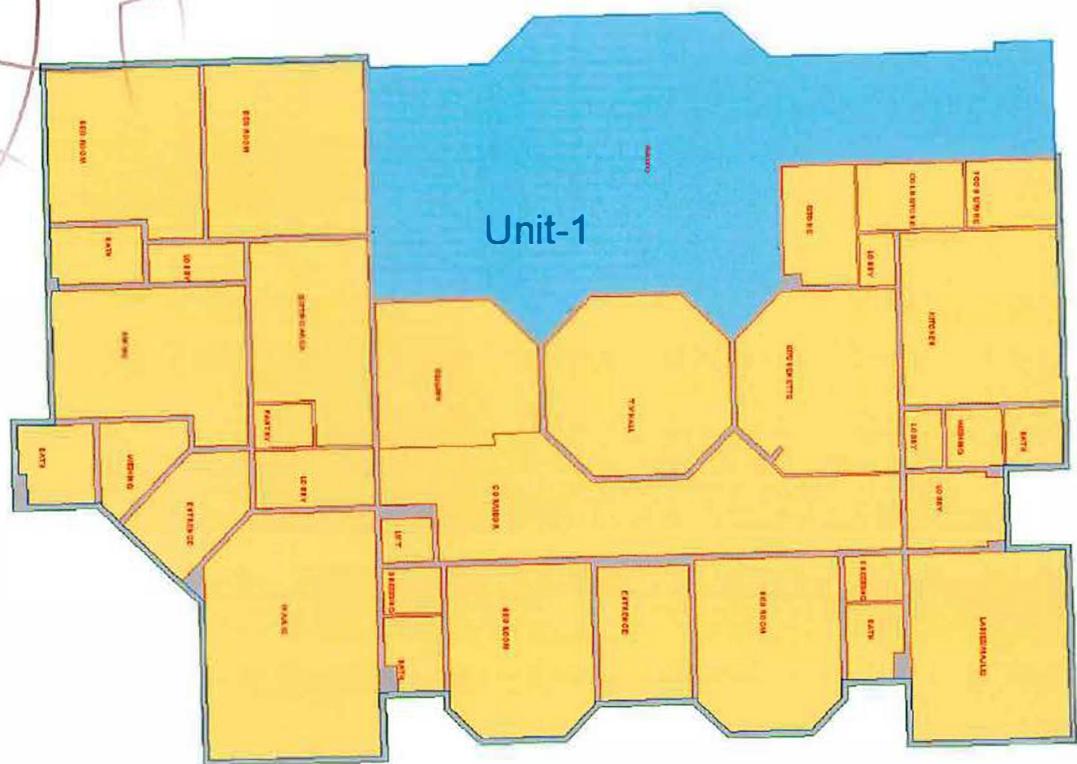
مساحة الطابق العلوي تستثنى المساحات غير المستخدمة من حساب المساحة.
